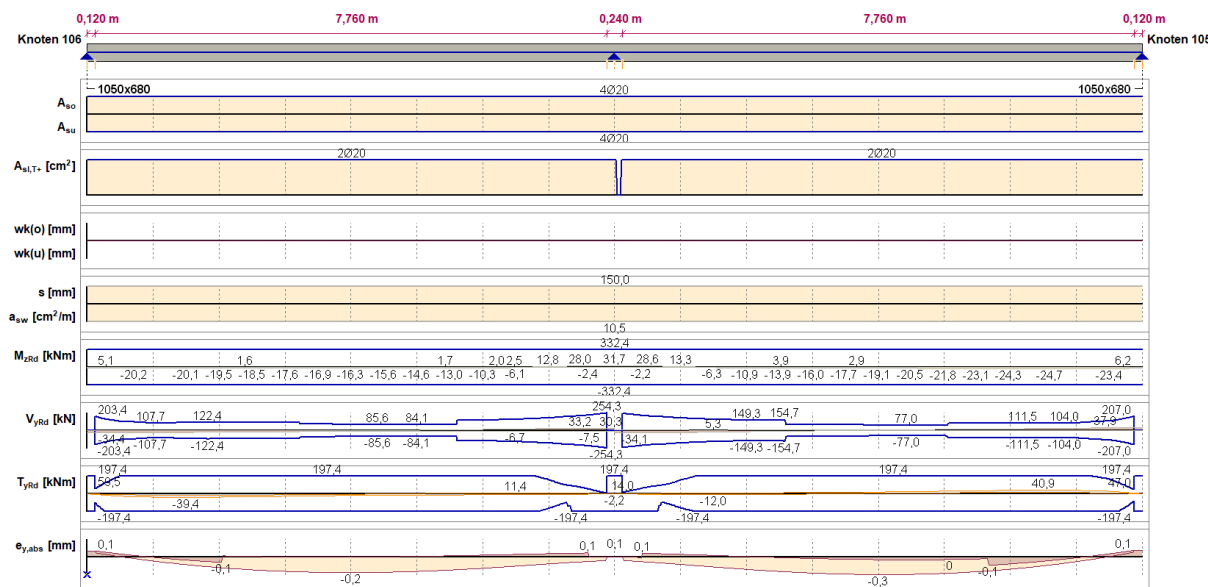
Berechnete Balkenbewehrung Querschnitt 680x1050, horizontale Ebene (Achse A)
